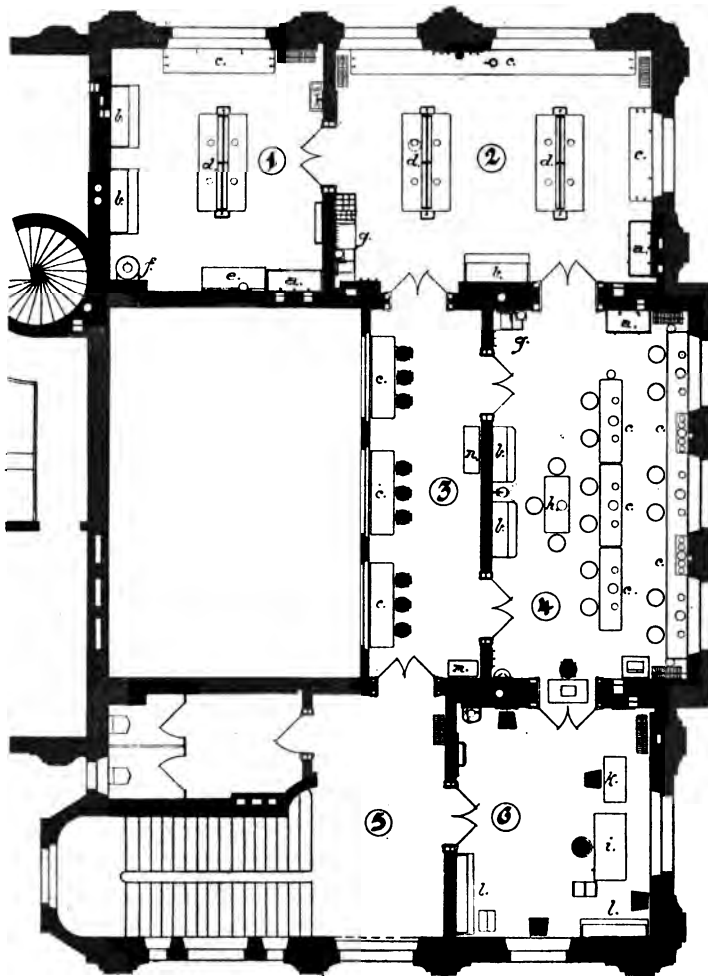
Abb. B I. Medic.-klinisches Institut. Erstes Obergeschoss. Grundriss.
